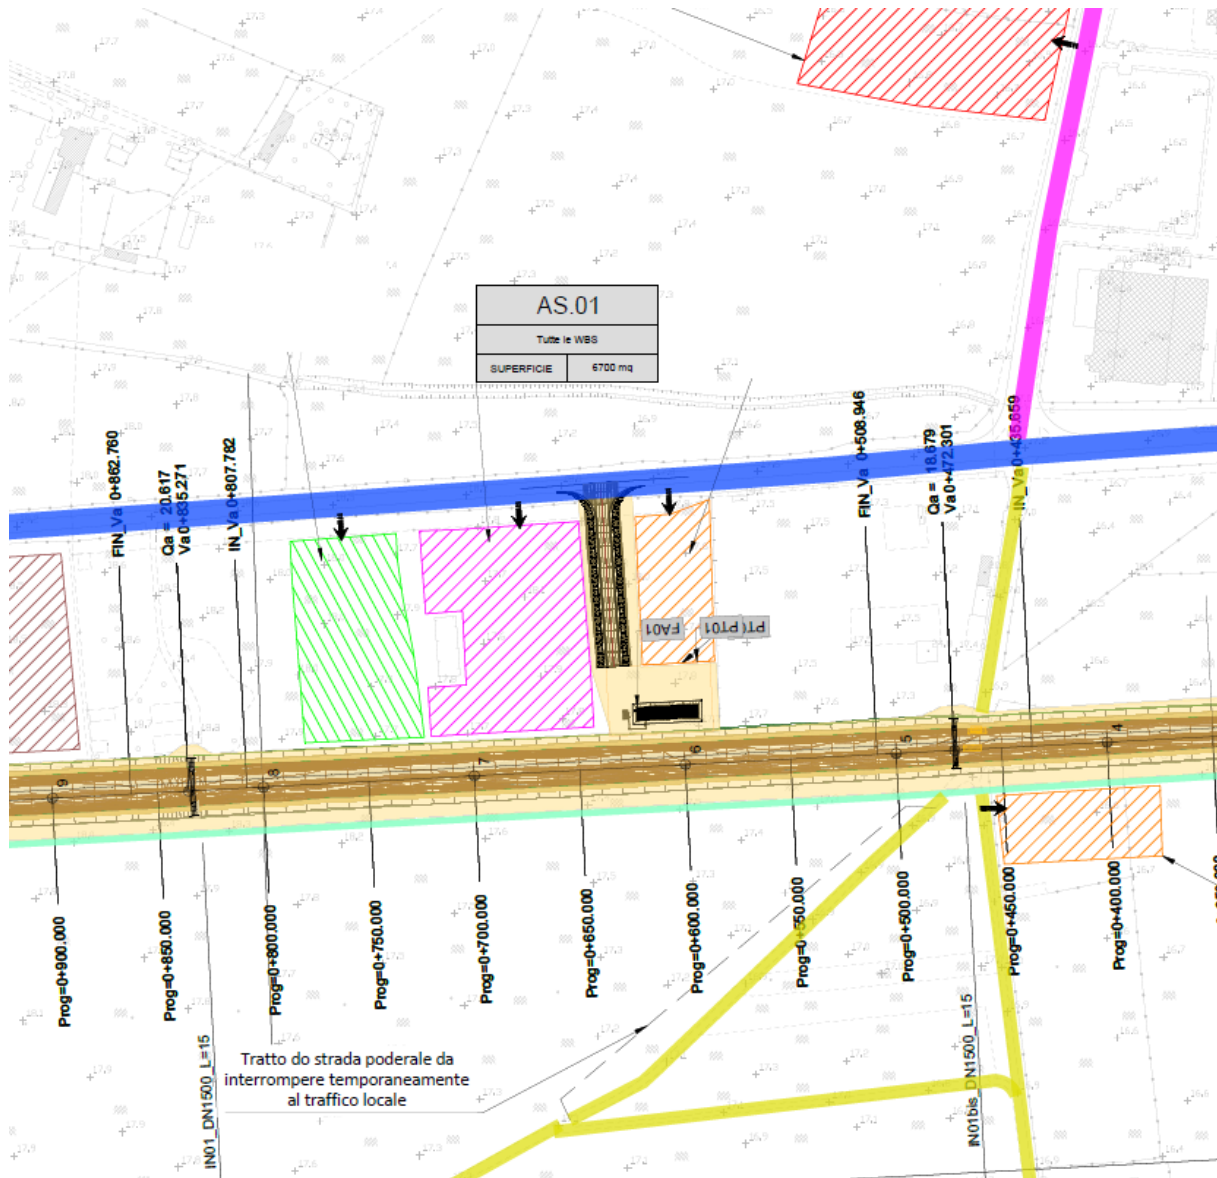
Vista in pianta dell'area di cantiere AS.01
